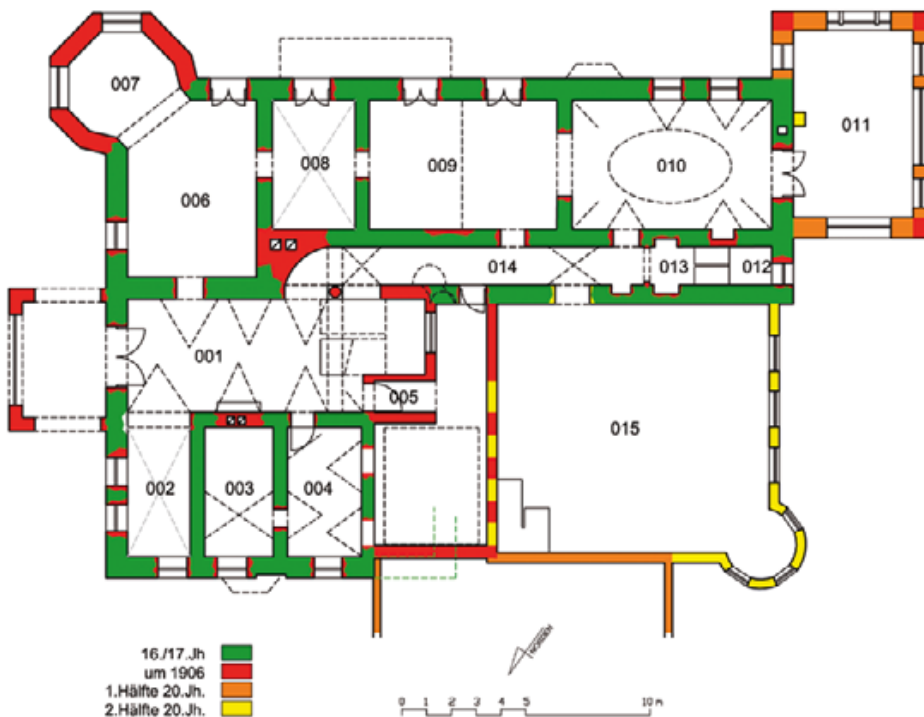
Furth, Schloss Treglwang-Paltenstein. Baualterplan des Erdgeschoßes.
